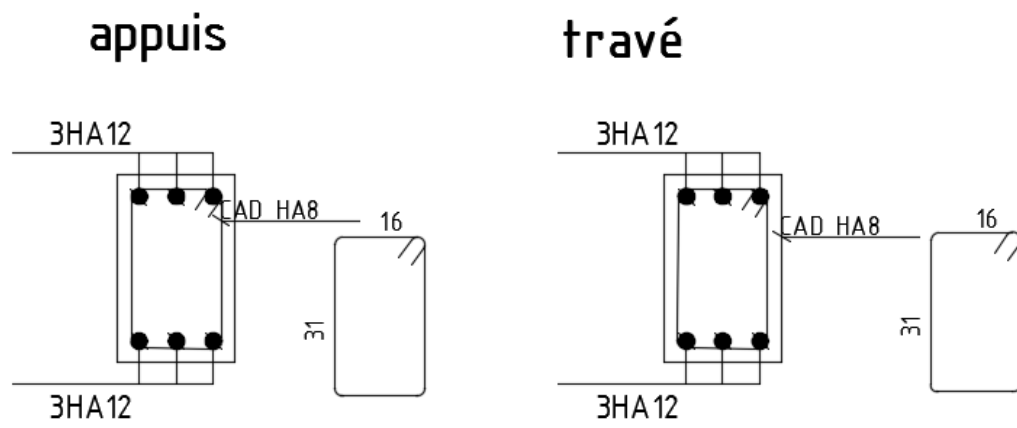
Ferraillage de la poutre secondaire (25x40)
